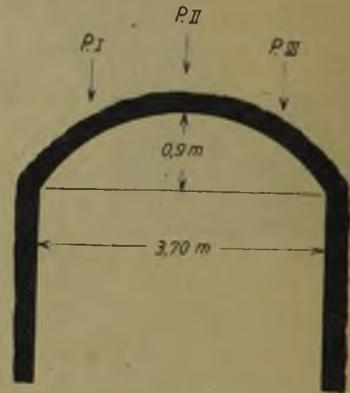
Aufhauen mit rundem Stoß und Härtepunkten.
